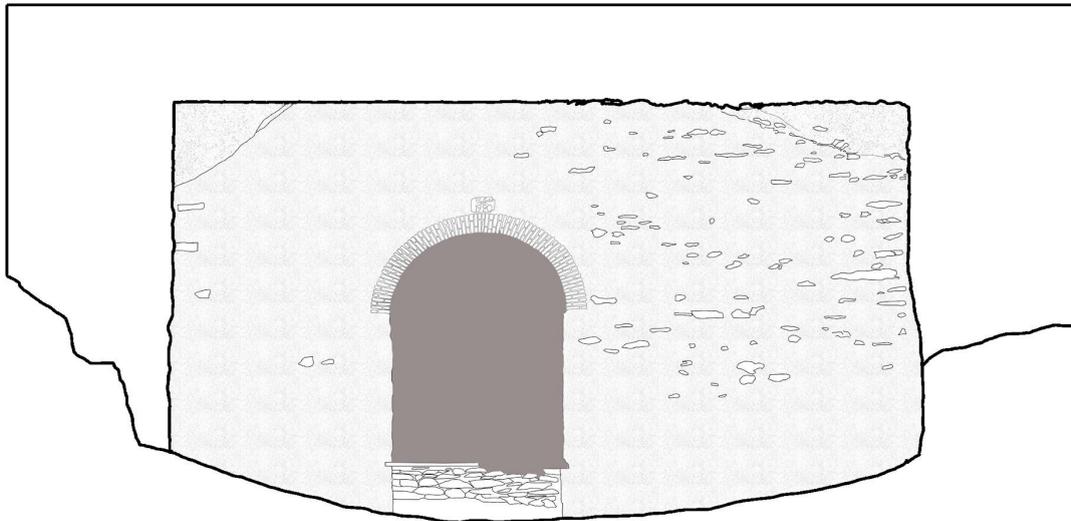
Andriani Mario. prospetto nord-est - edificio principale
